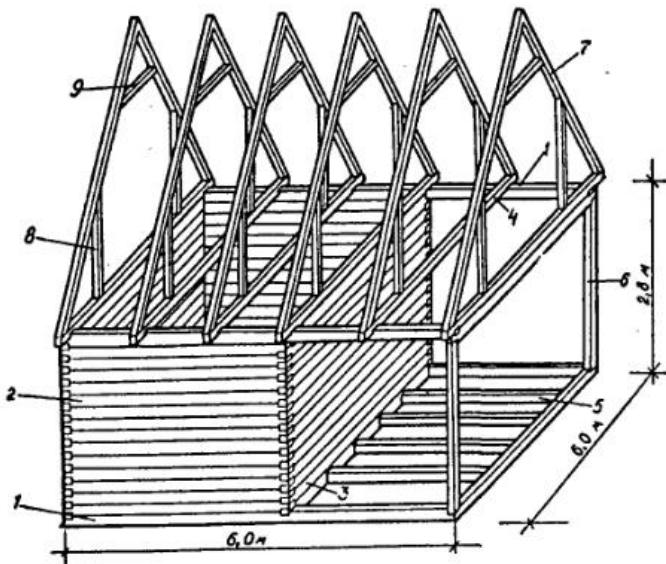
Монтажная схема сруба: 1 — брус продольной стены нижнего и верхнего венца; 2 — рядовой брус продольной стены; 3 — рядовой брус поперечной стены; 4 — балка; 5 — лага; 6 — стойка стены веранды; 7 — стропила; 8 — стойка стропил; 9 — стяжка.
